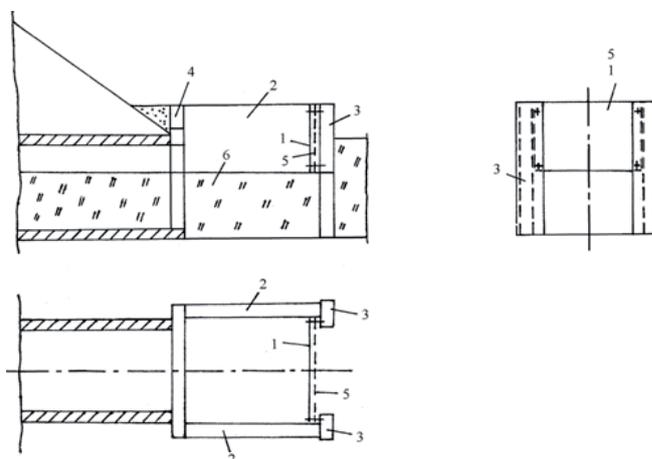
Входной оголовок водопропускной трубы с противоналедным щитом: 1 — противоналедный щит; 2 — открывок; 3 — брус для крепления щита; 4 — надпортальная стенка; 5 — геомембрана; 6 — наледь
